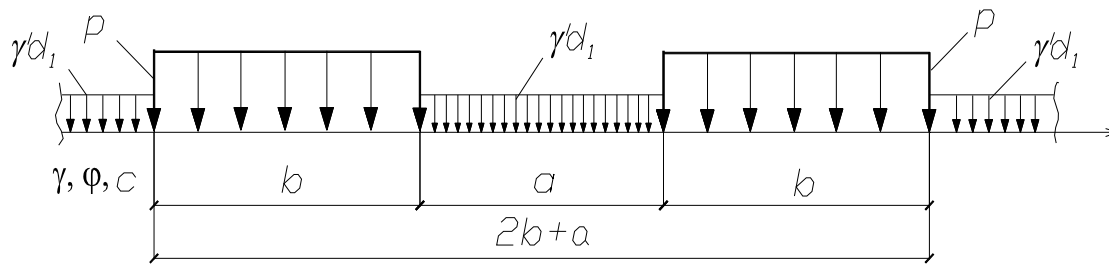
Розрахункова схема взаємодії фундаменту з ґрунтовою основою
